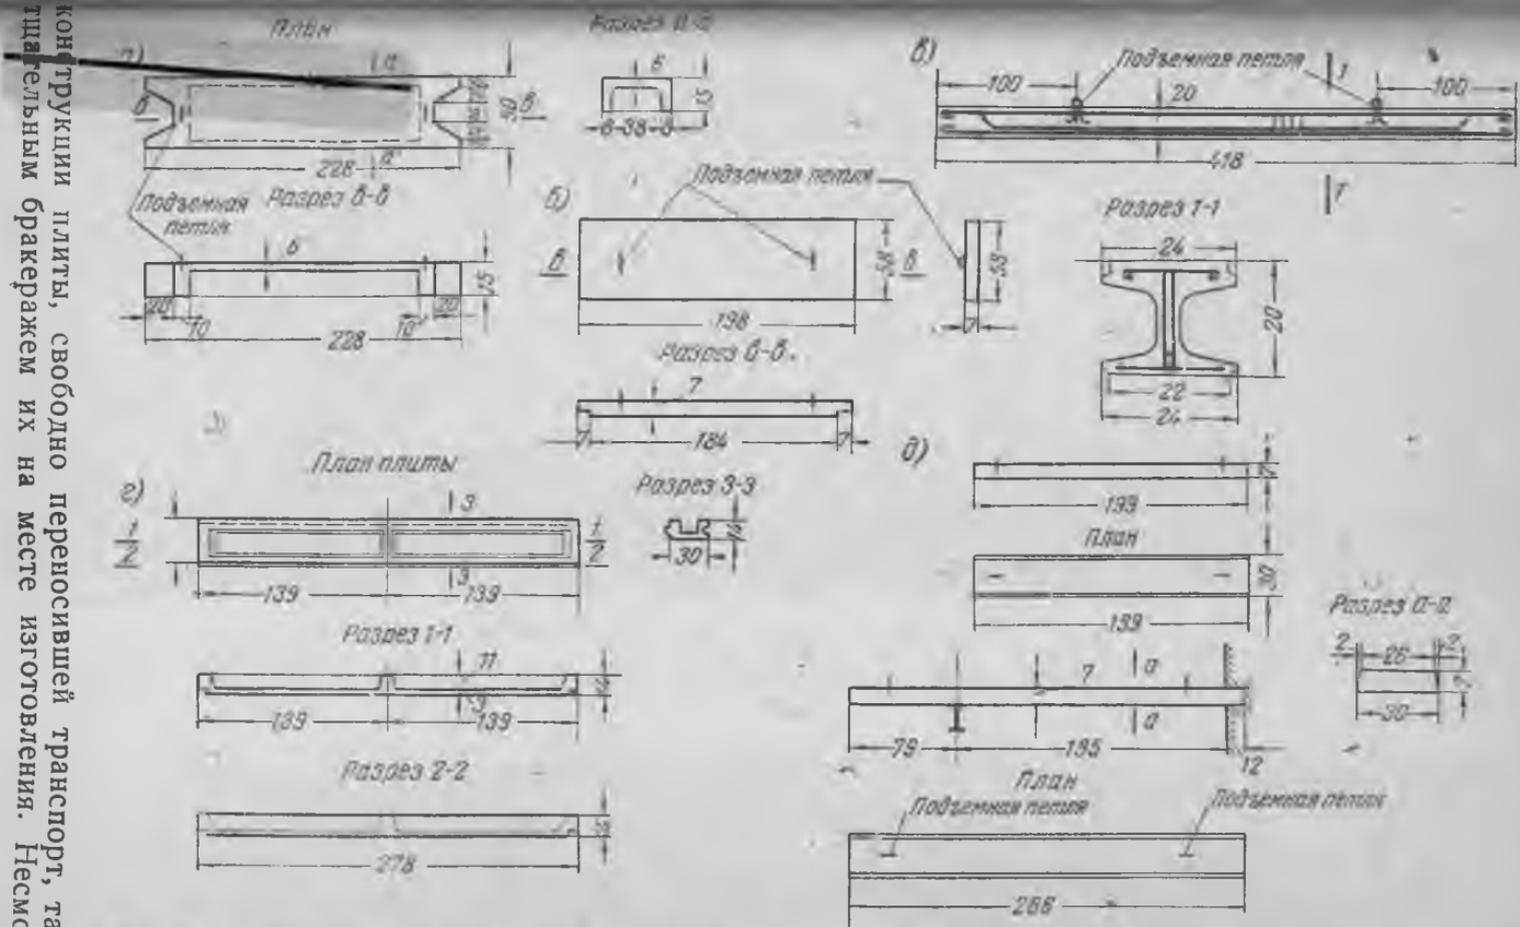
а — сборная плита над подвалом; б — сборная плита над гаражом; в — блок „Рapid“; г — плиты санитарных узлов; д — сборные плиты лестничных площадок.
